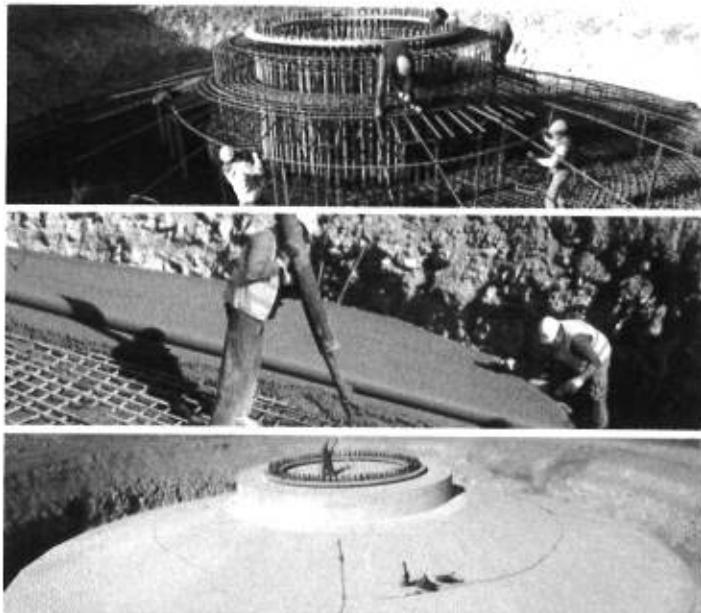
Les étapes de construction d'une fondation pour une éolienne NORDEX (Source : NORDEX)
